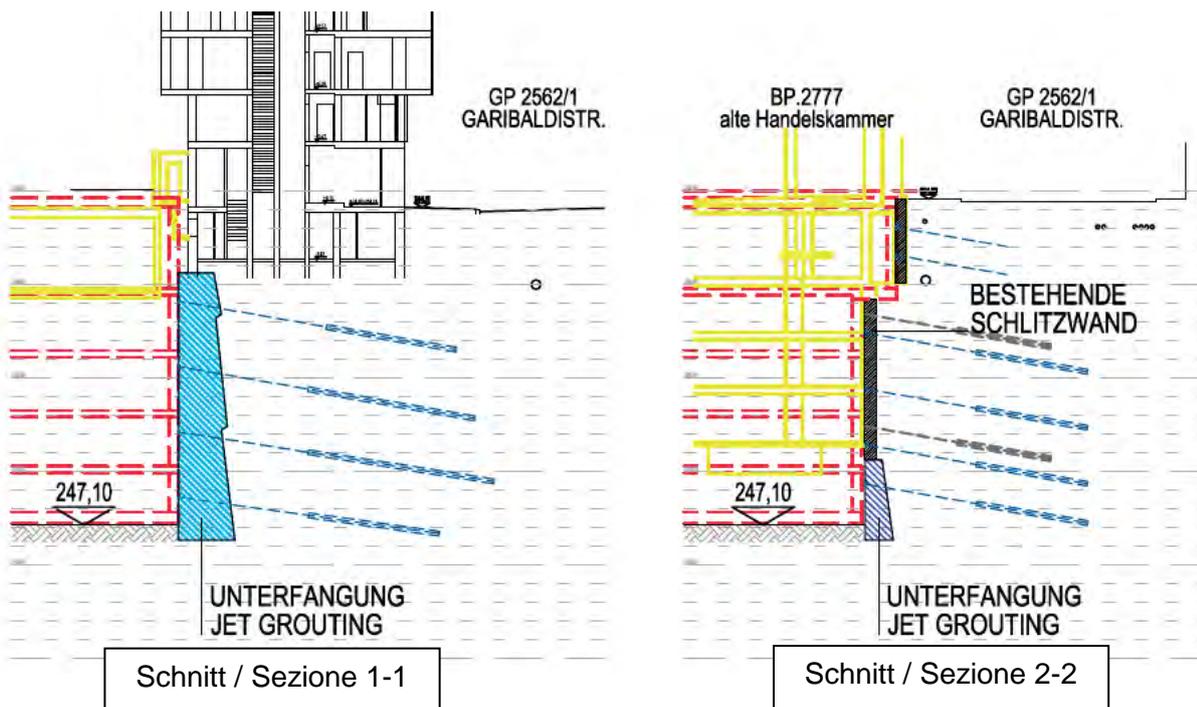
Typenschnitte Baugrubenverbau Jet Grouting
